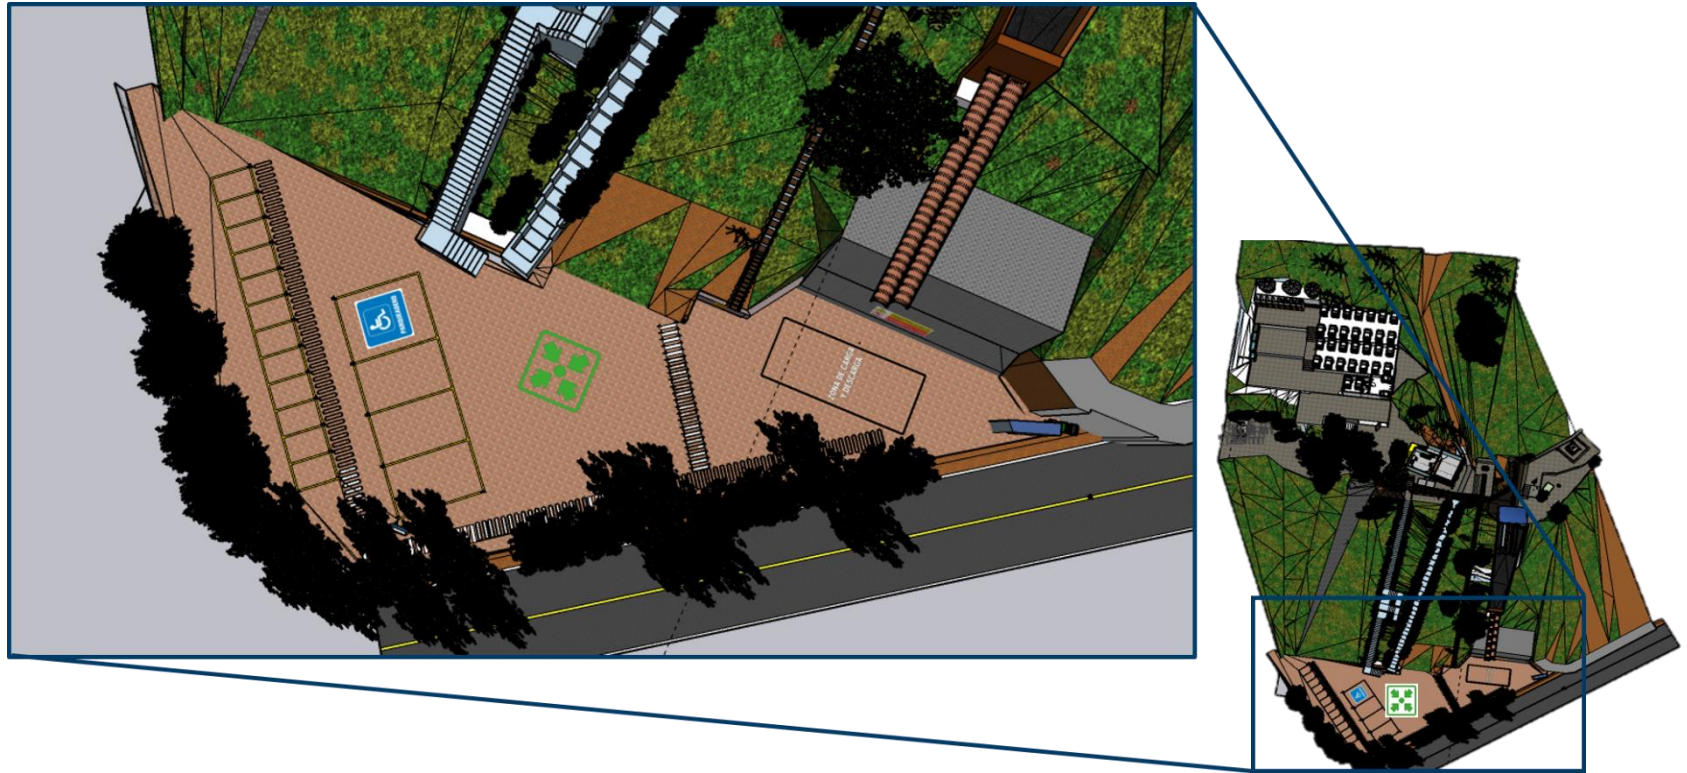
Vista superior de la planta baja-Fuente: elaboración propia
